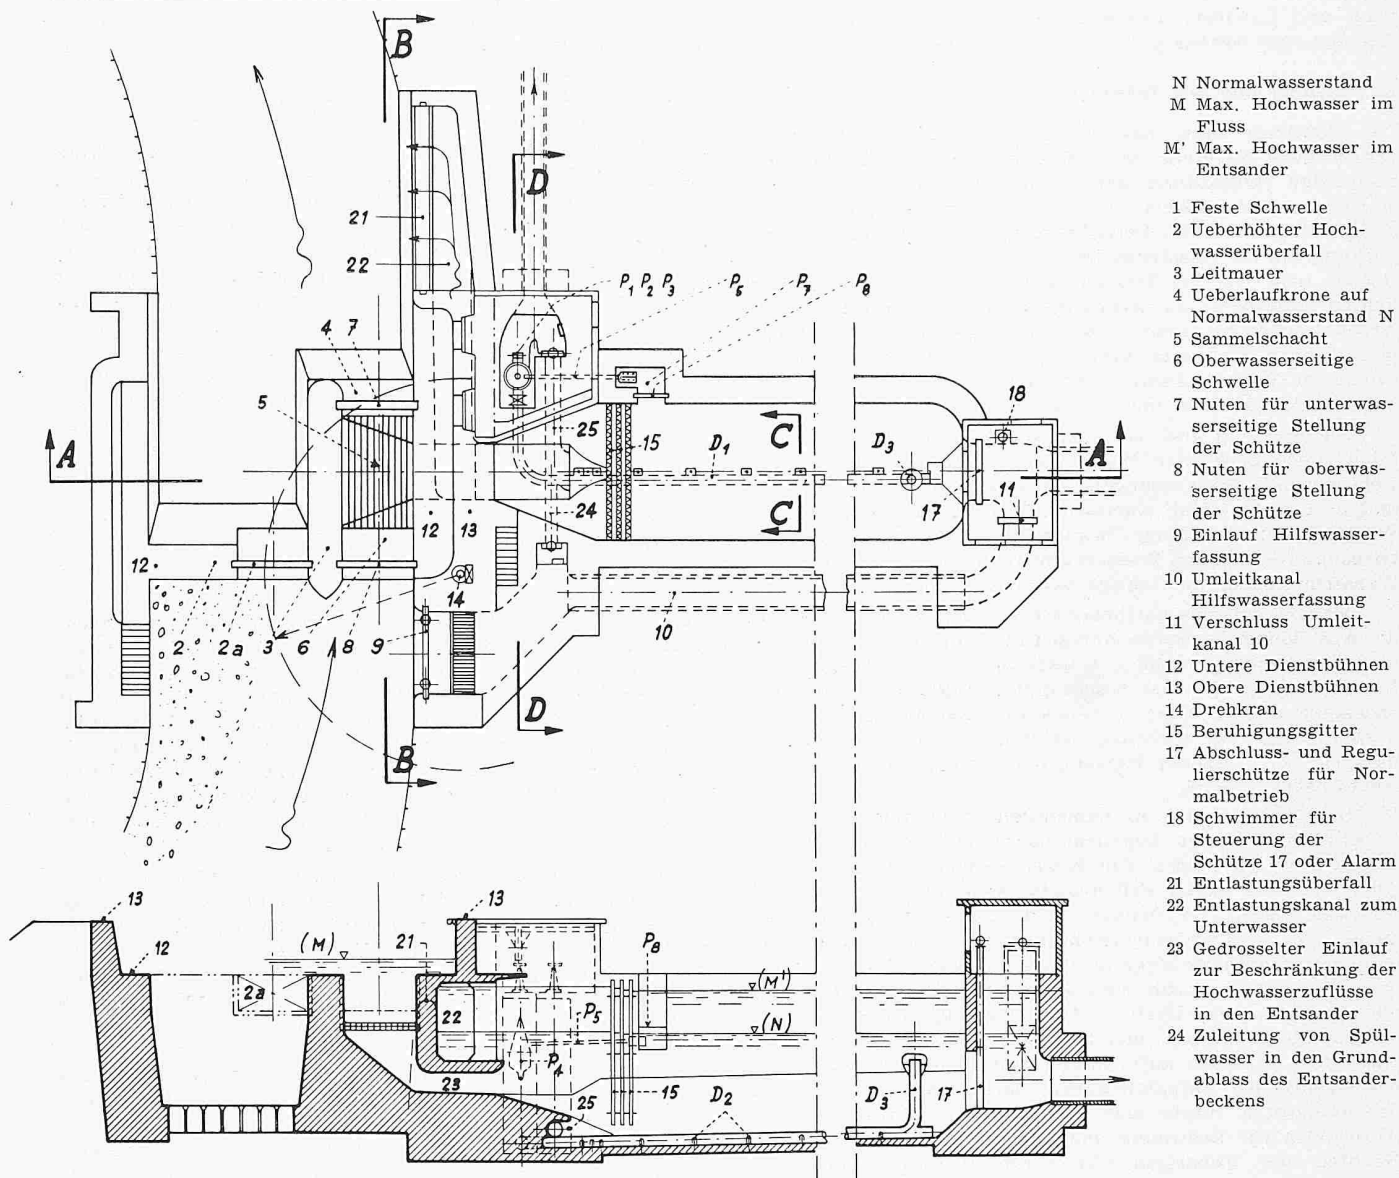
Grundriss und Schnitt A-A der Wasserfassung nach Entwurf des Verfassers
